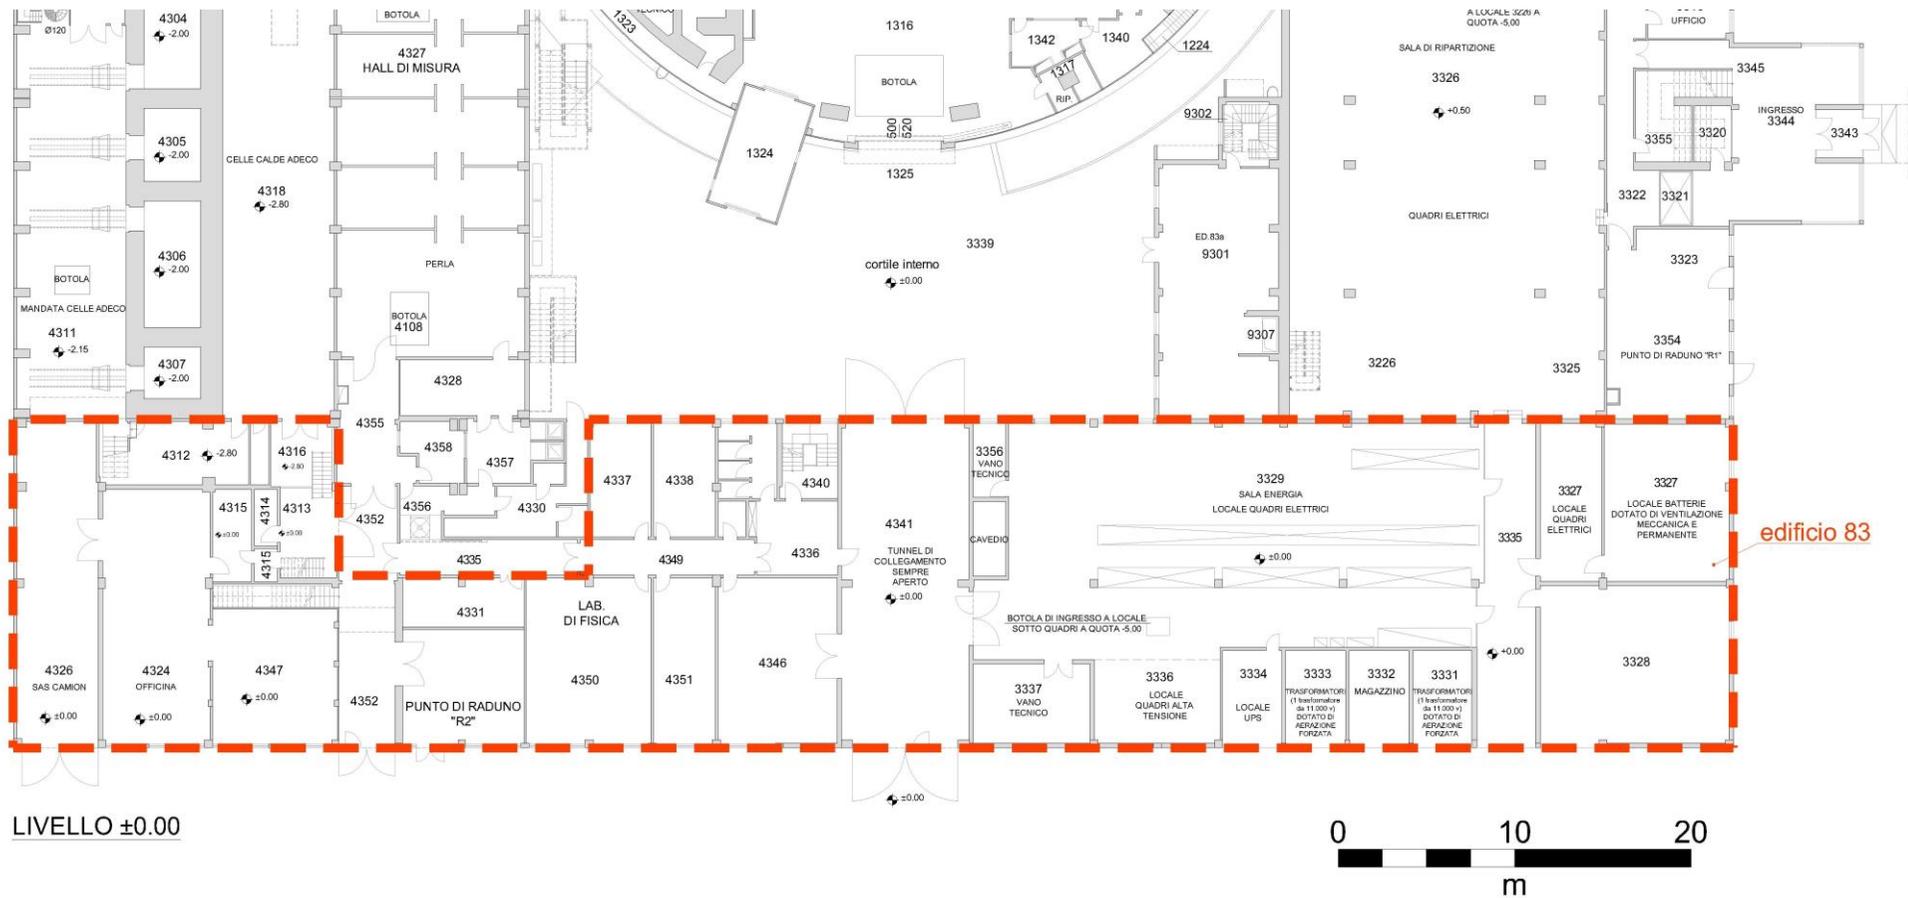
Edificio 83 – Layout a ±0,00 m
